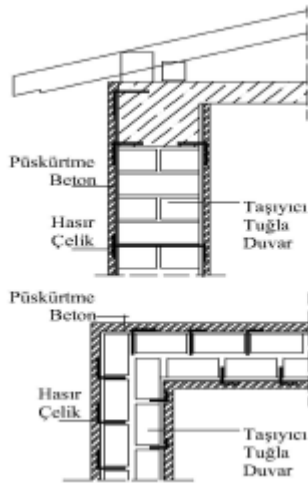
Püskürtme betonu-ıslak sistem (Bekişoğlu, 1993)
